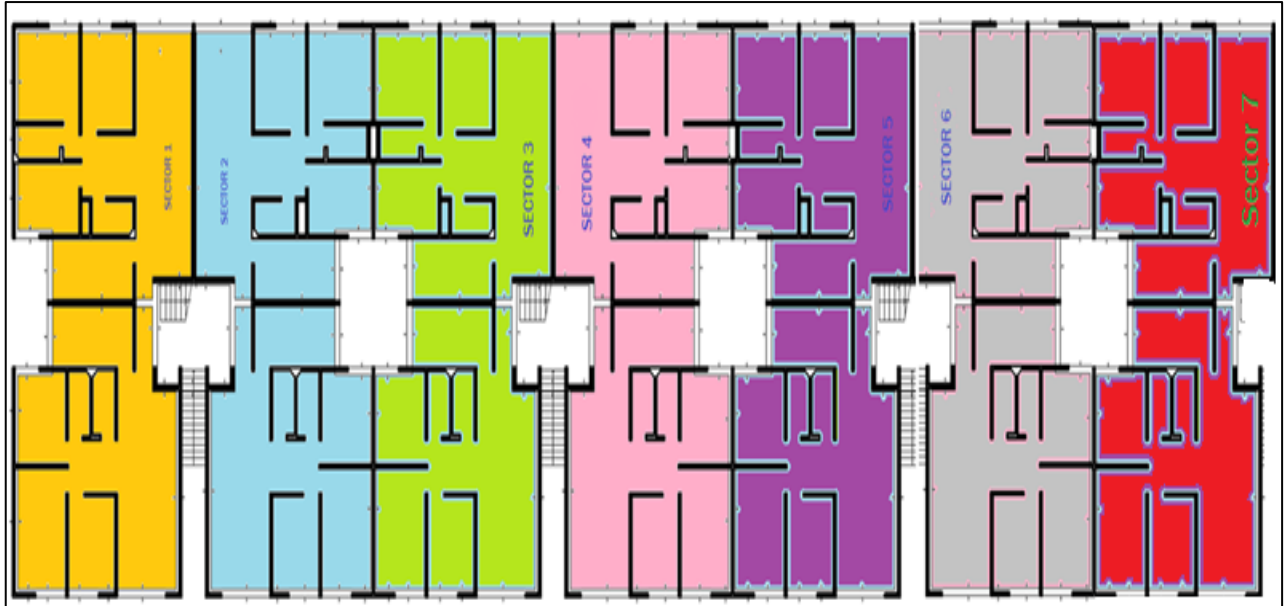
Vista en Planta de Sectorización de Vaciado del Edificio
